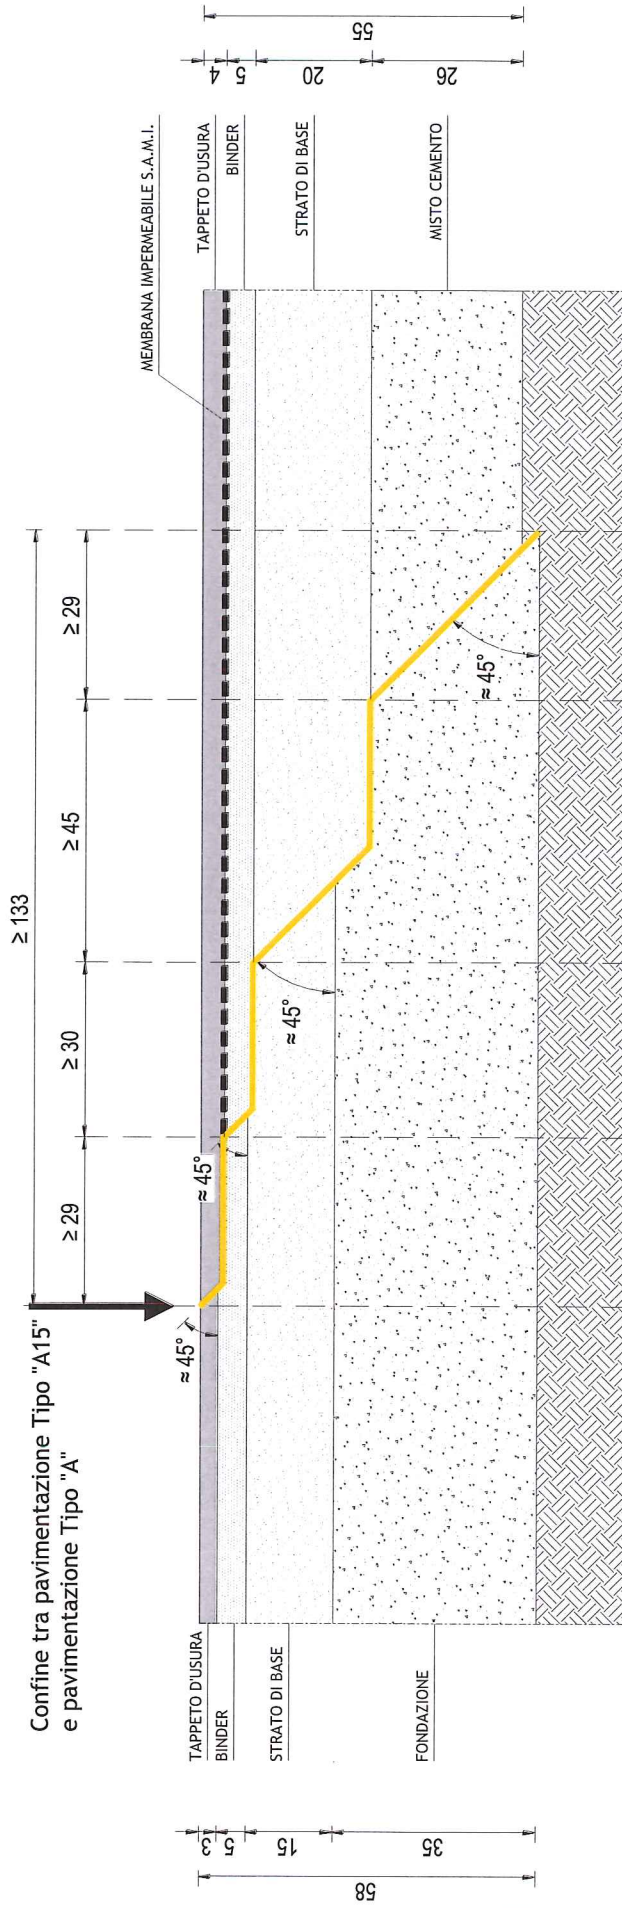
dettaglio della transizione tra pavimentazione tipo "A15" e tipo "A"
